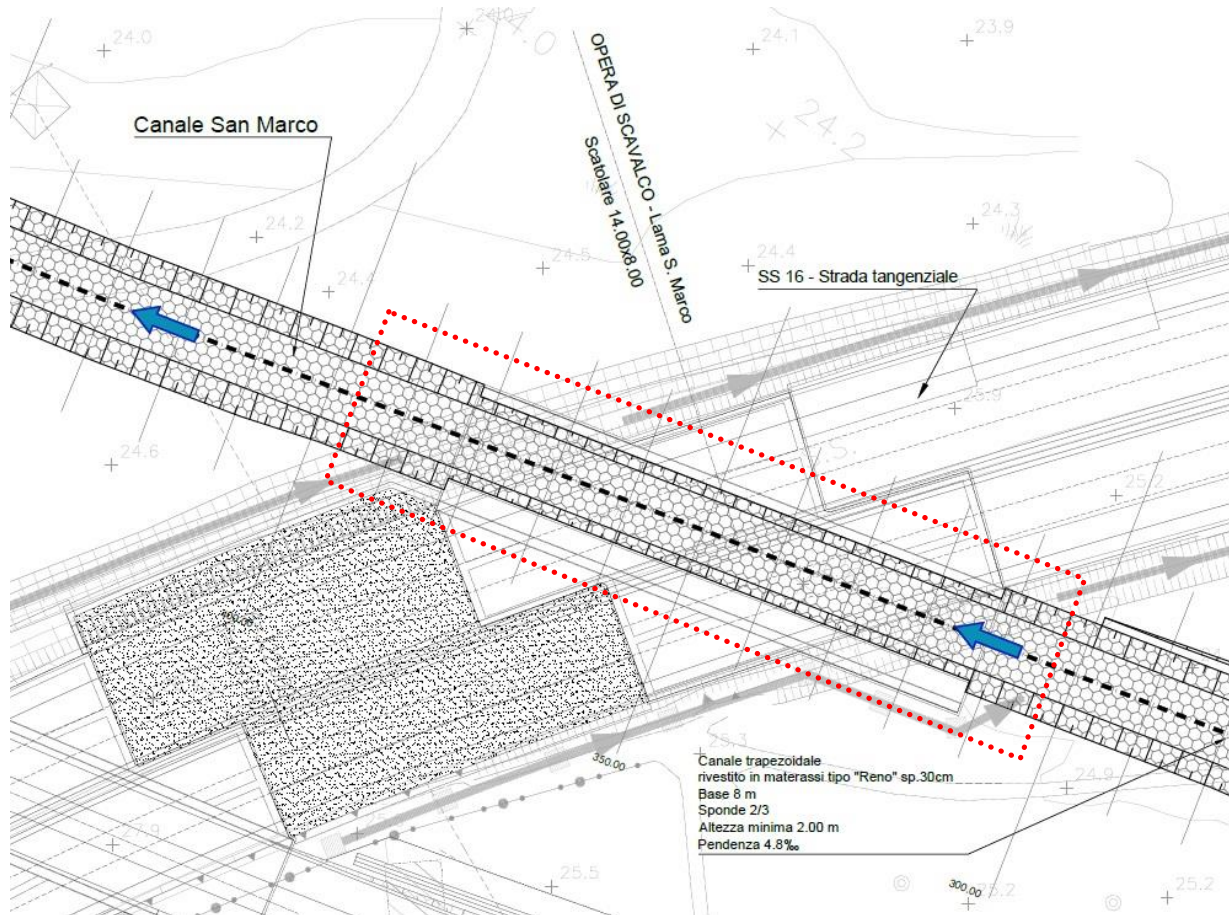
Planimetria dell'opera di scavalco Lama San Marco SS16
